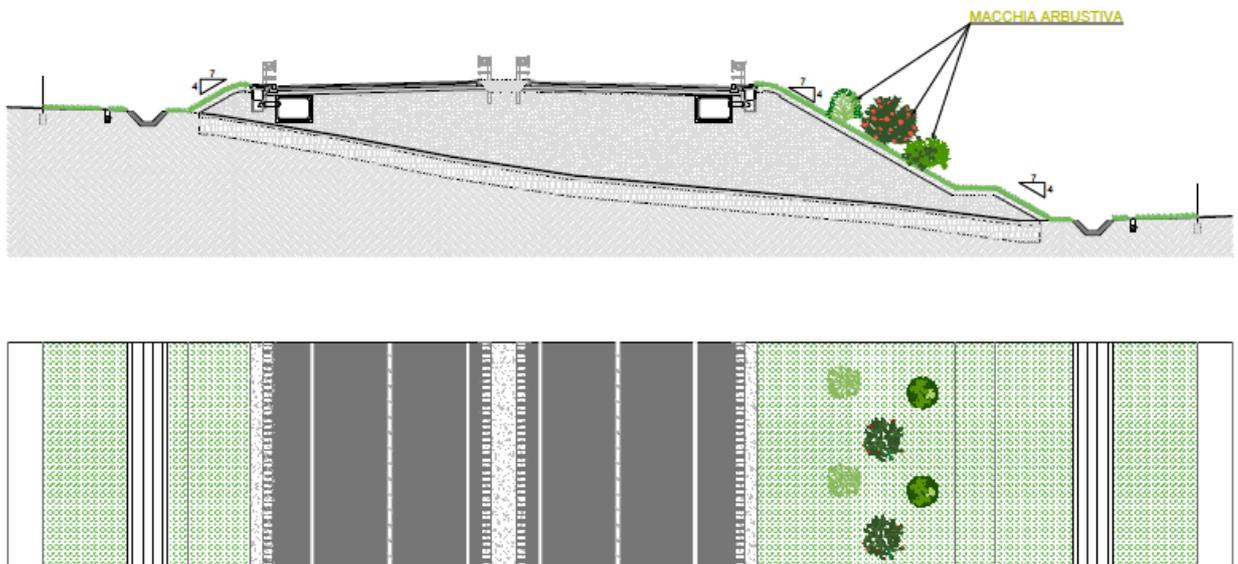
Planimetria e sezione degli interventi di mitigazione arbustiva su rilevato
